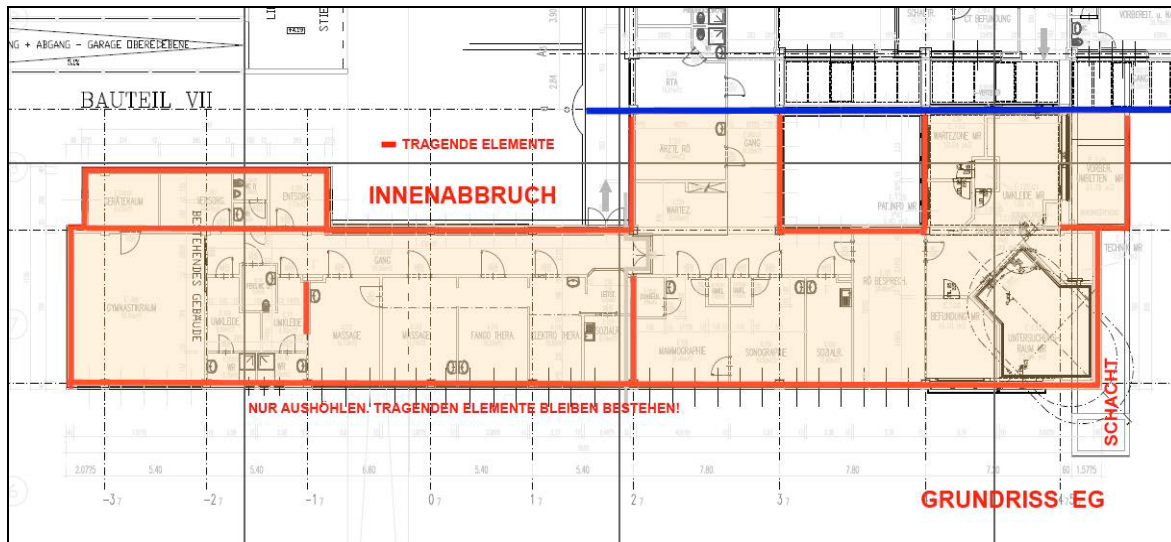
Abbruchkosten - LKH – Feldbach Bauteil VII Grundriss Erdgeschoss EG
